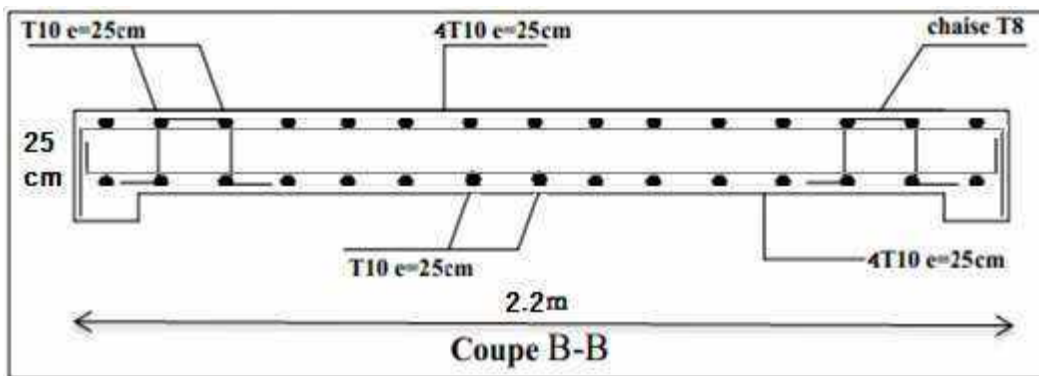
Ferrailage de la dalle machine coupe B-B
